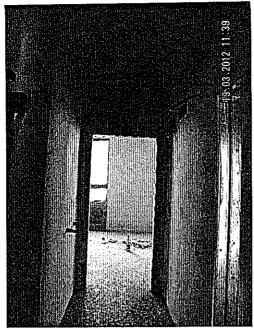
Vano scale: Vista porta ingresso stanza_1.1
